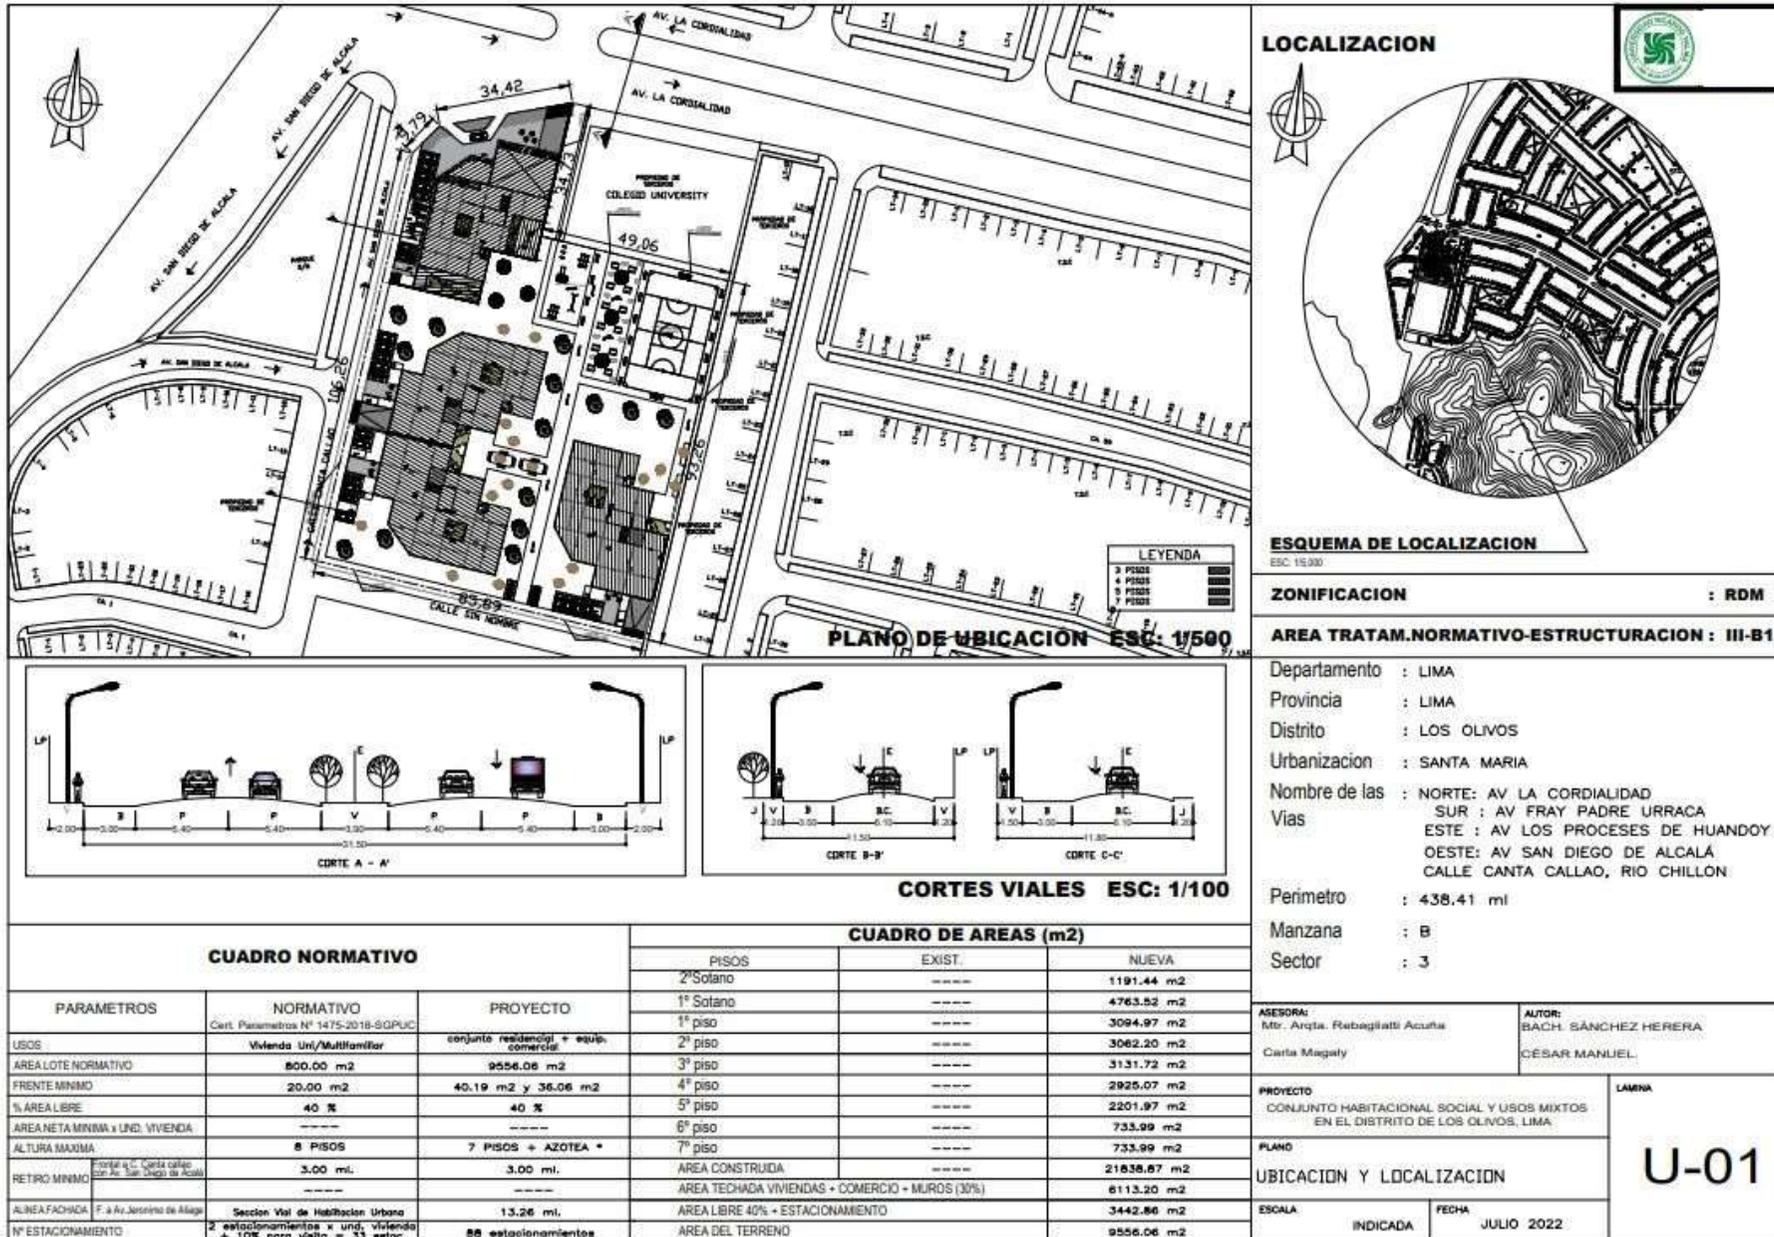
plano de ubicación y localización (proyecto en los olivos), Fuente: elaboración propia.
